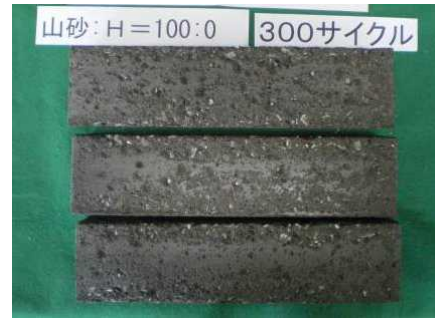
凍結融解試験の状況 (No. 1 300 サイクル)
